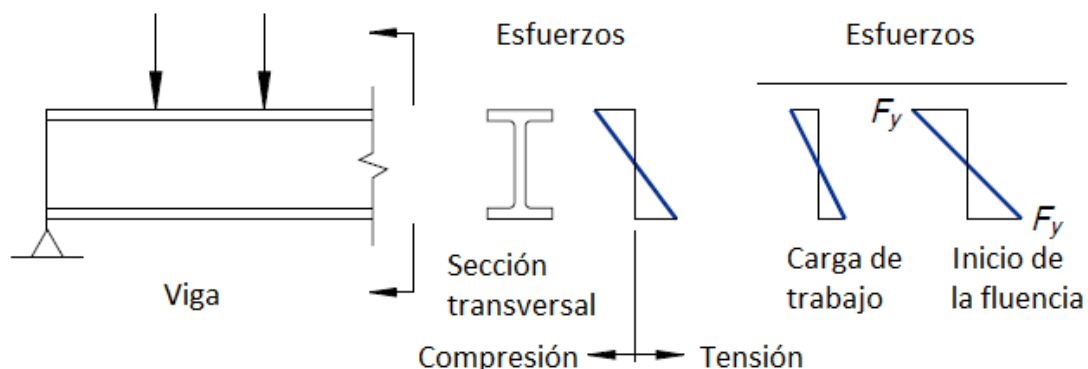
DISTRIBUCIÓN DE ESFUERZOS EN LA SECCIÓN TRANSVERSAL DE UNA VIGA
